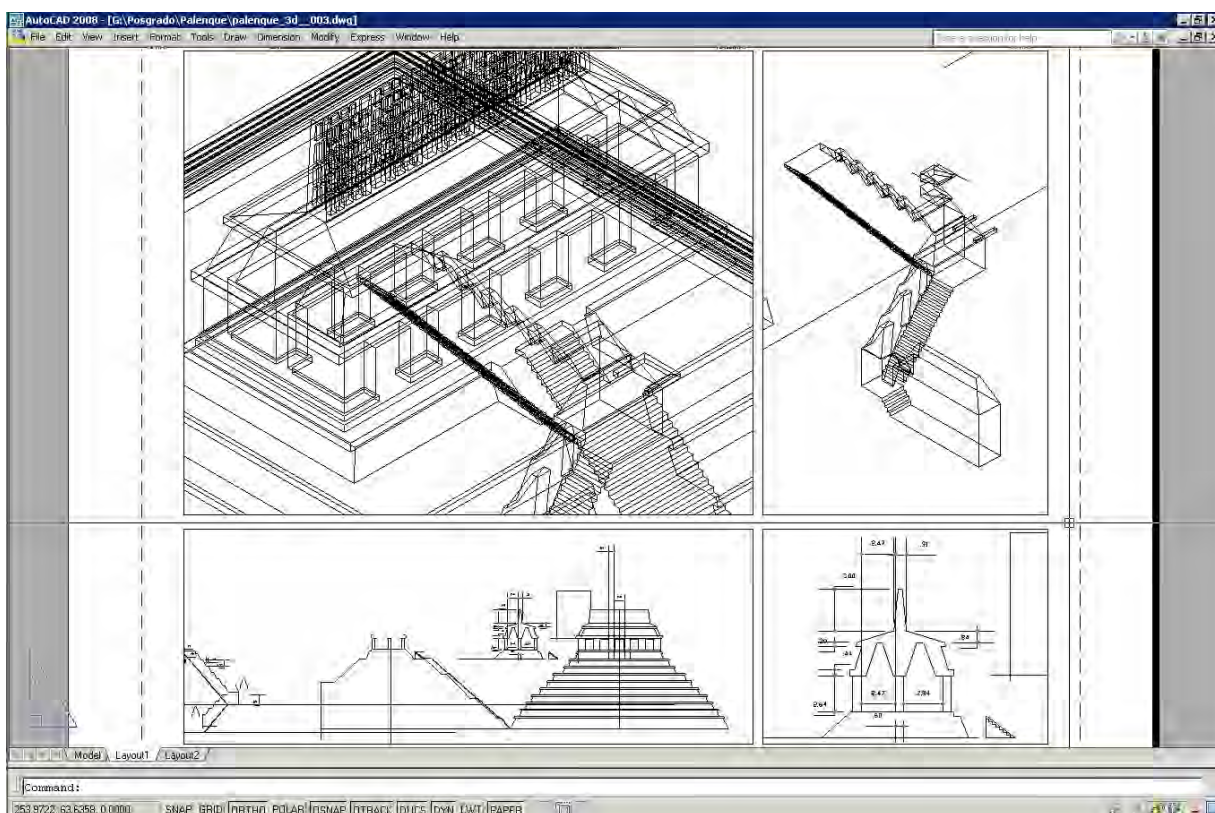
Planos desarrollados en AutoCAD con vistas frontal, corte e isométrico. (Realizado por el autor, 2014).
